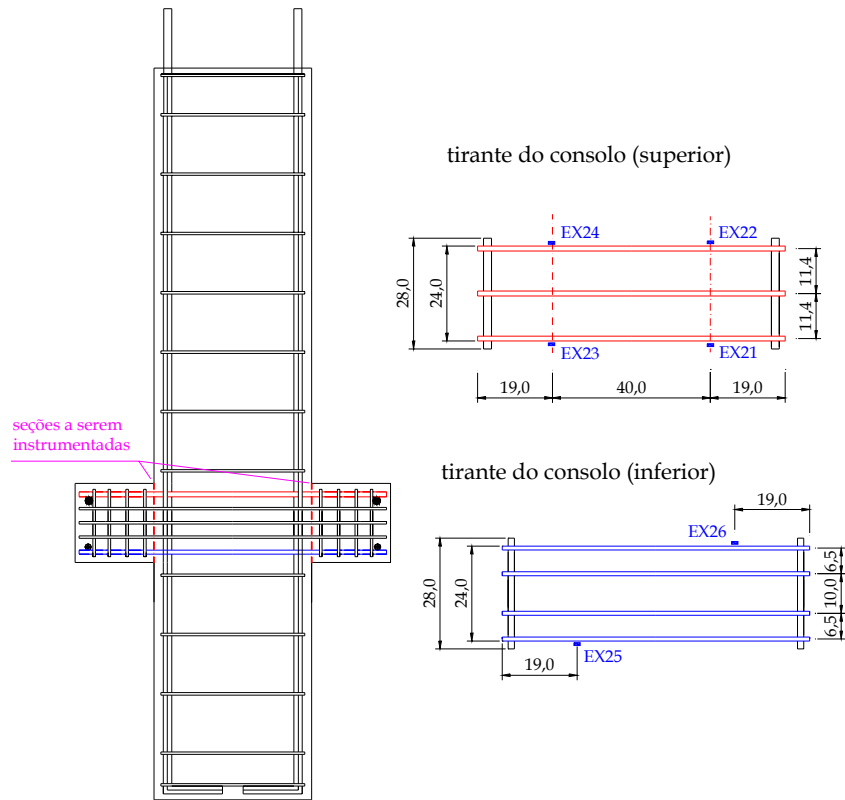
Instrumentação da armadura do pilar (dimensões em cm).
